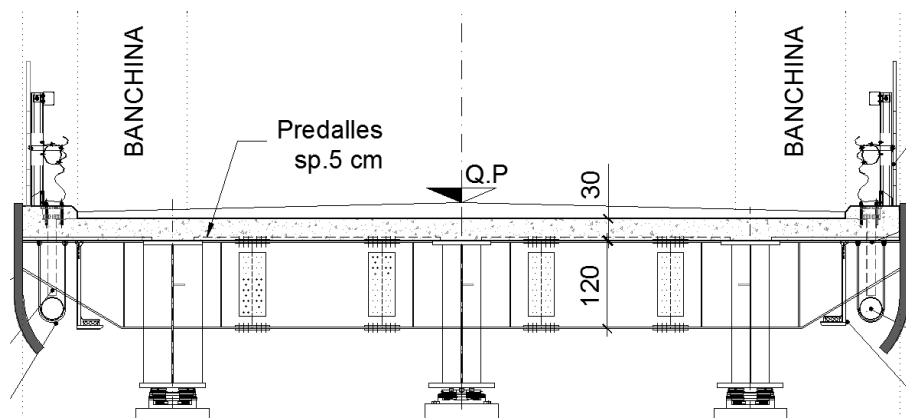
Sezione trasversale dell'impalcato campate laterali
